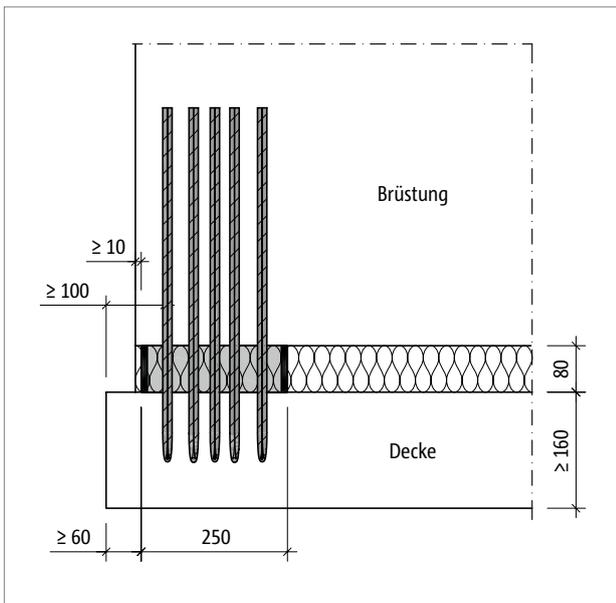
Schöck Isokorb® T Typ AP: Ansicht Randabstände
